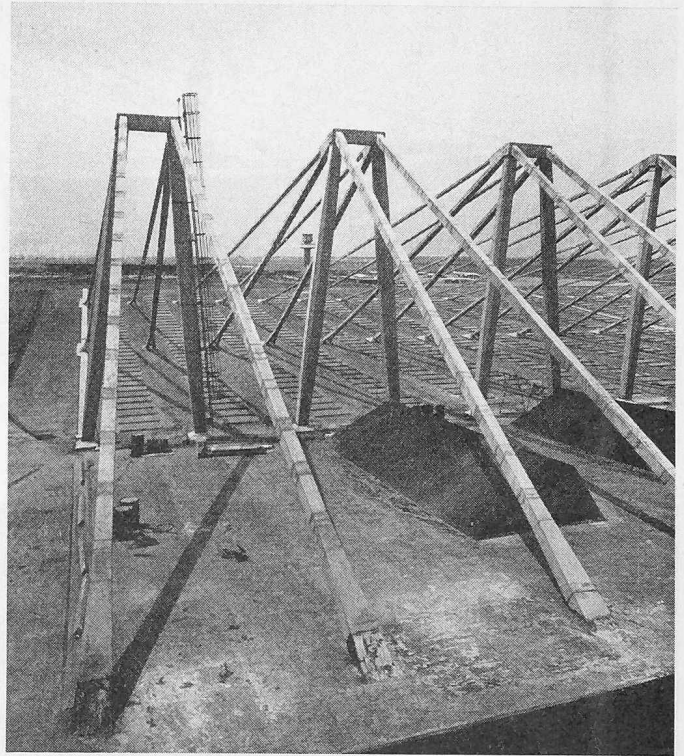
Rückwärtsverankerung (vorne im Bild) der Dachplatte mittels Zugseilen. Die Umhüllungen der Zugseile sind statisch erforderlich
